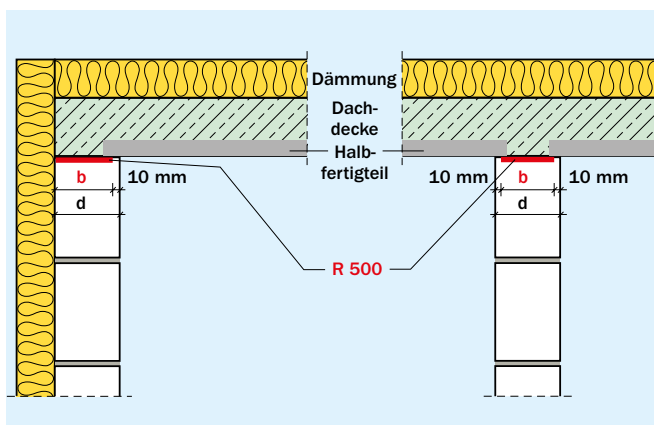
Trennschicht zur Aufnahme der Schwindverkürzung der Stahlbetondecke im obersten Geschoss unter Beibehaltung der oberen Halterung
